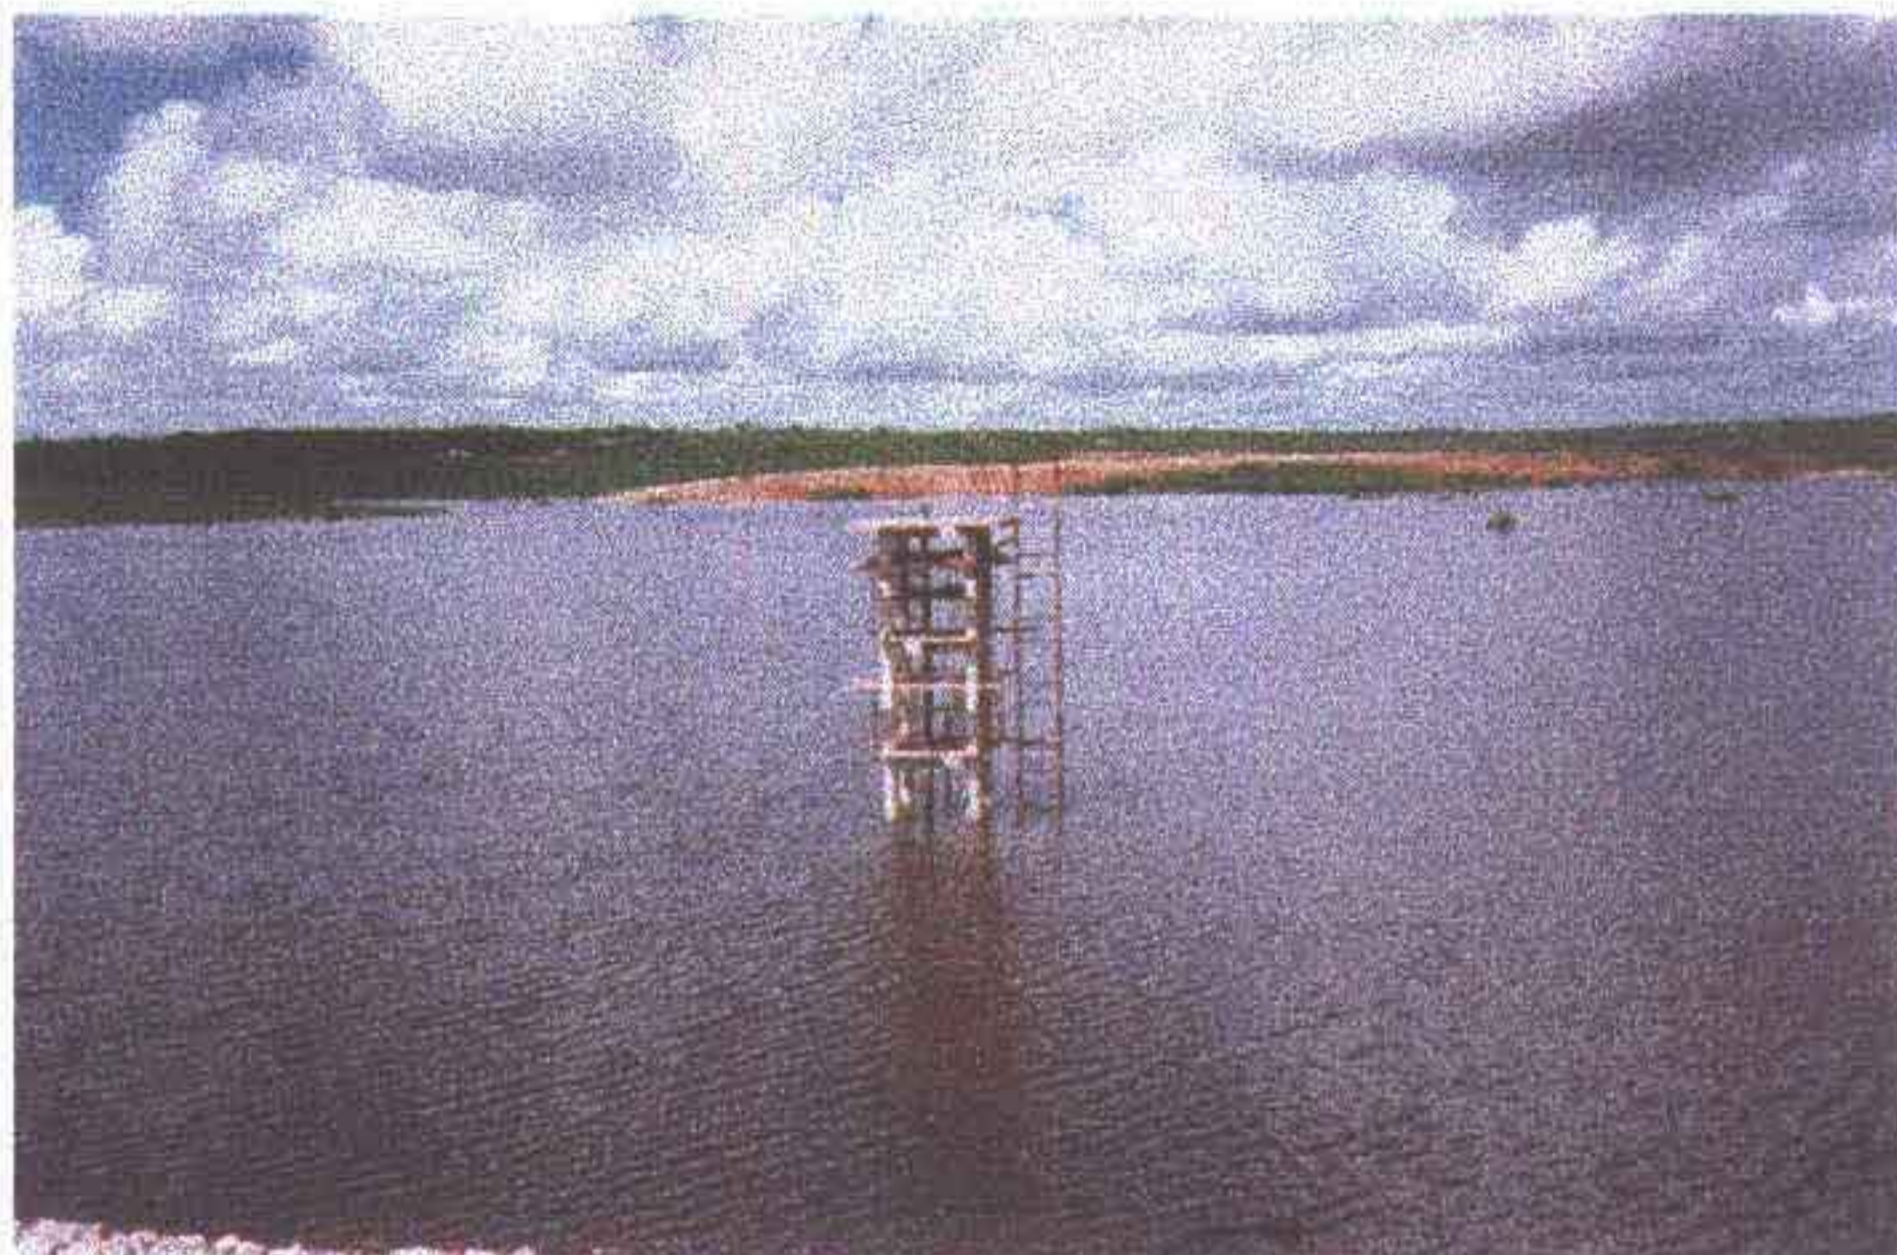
Torre faltando a concretagem dos últimos pilares e do teto.
